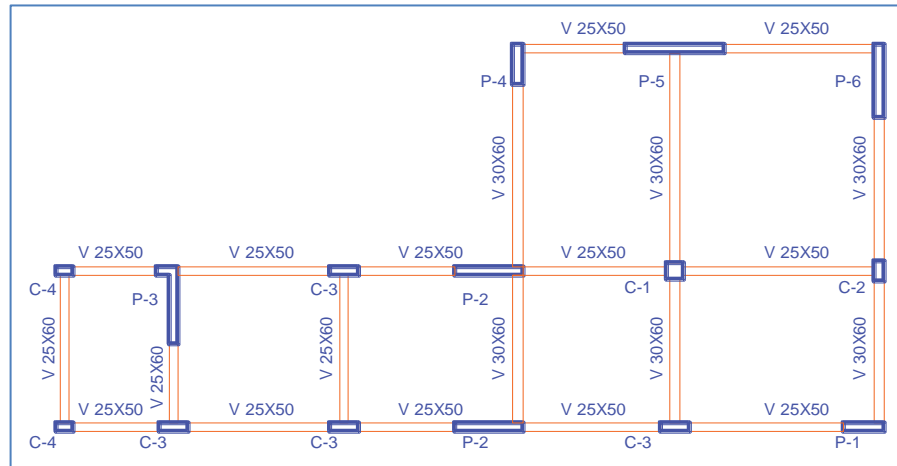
Vista en planta de la configuración del sistema de muros estructurales Fuente propia
